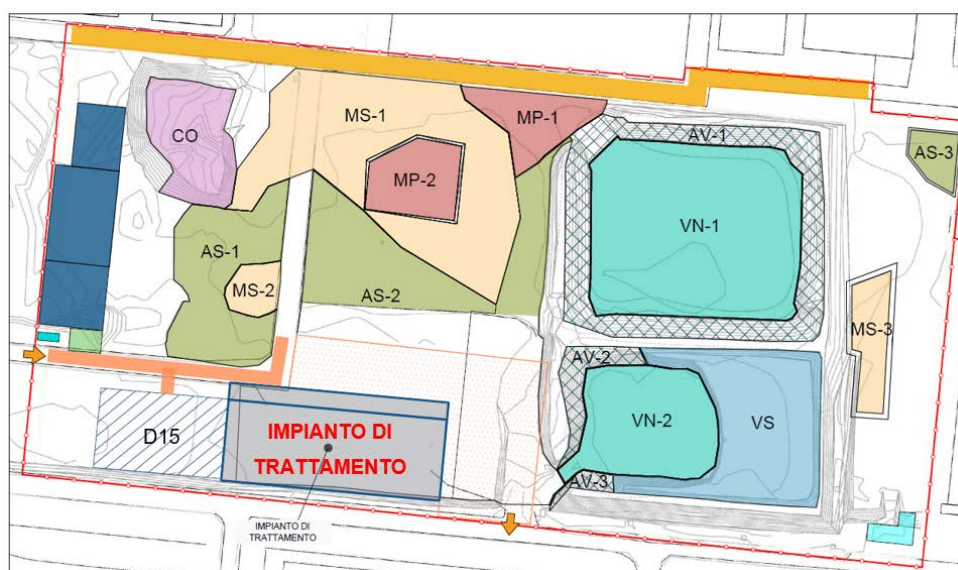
Planimetria area palte con individuazione delle zone di scavo, del deposito preliminare D15 e del capannone destinato ad ospitare l'impianto di trattamento
